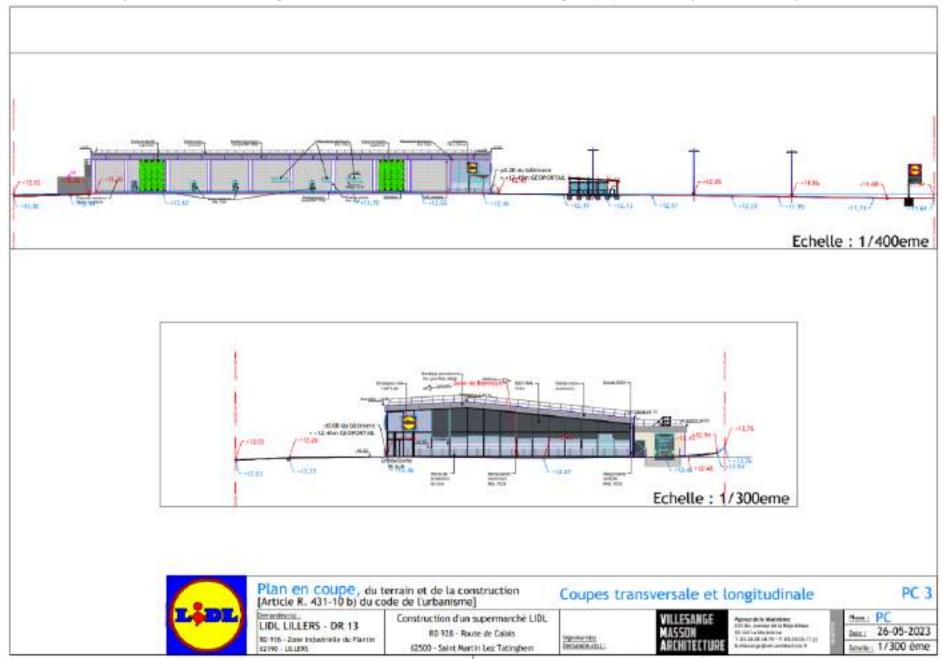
Coupe transversale et longitudinale du projet; Source: Villesange Masson Architecture
